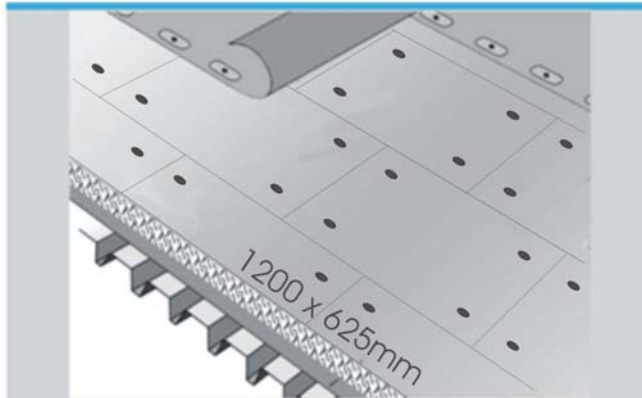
Symbolbild Befestigungsschema einer Stahlprofilblechdachkonstruktion
